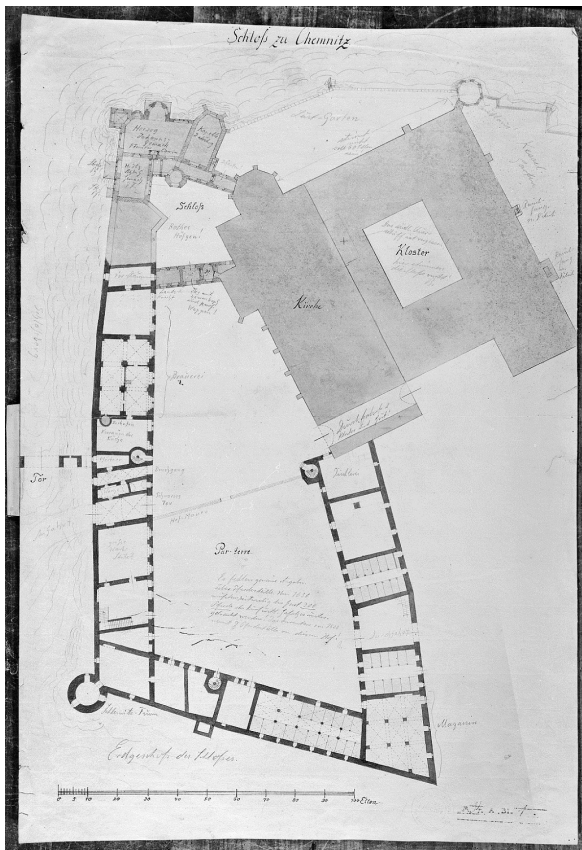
Grundriss, Schlosses zu Chemnitz, Erdgeschoss, lavierte Federzeichnung, 67,5 x 46 cm, 1. H. 18. Jahrhundert.
